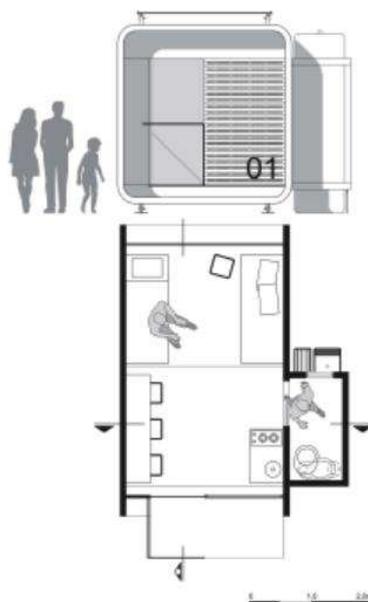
Planta baixa do abrigo emergencial efêmero desenvolvido pela arquiteta Giovana Feres.
